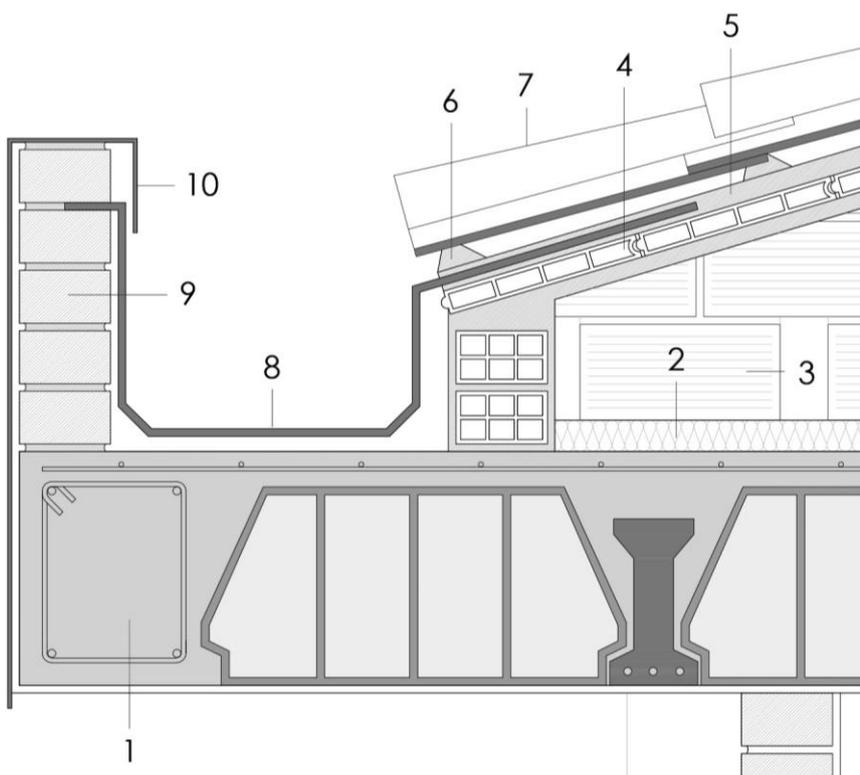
Zoom de la cubierta en la zona del antepecho E: 1/10
